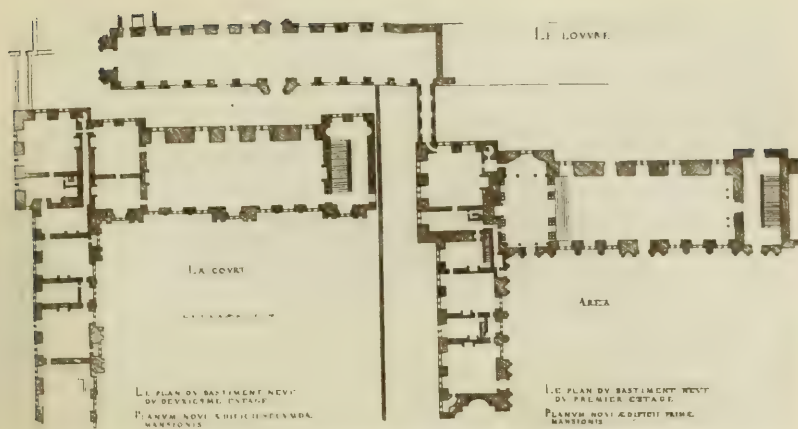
Pierre Lescot. Plan du Louvre (D'après Ducerceau).
